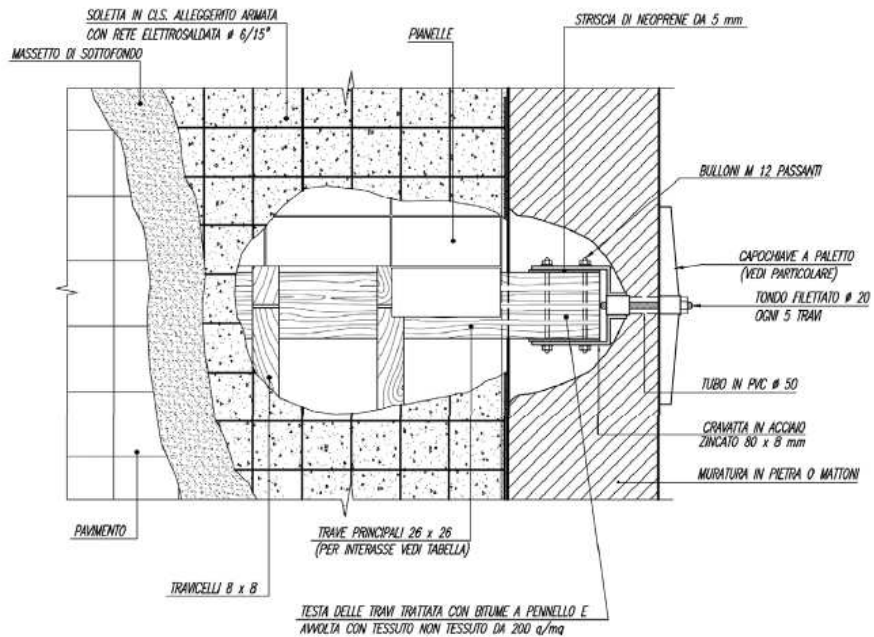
Particolare in sezione del tirante e del suo ancoraggio
